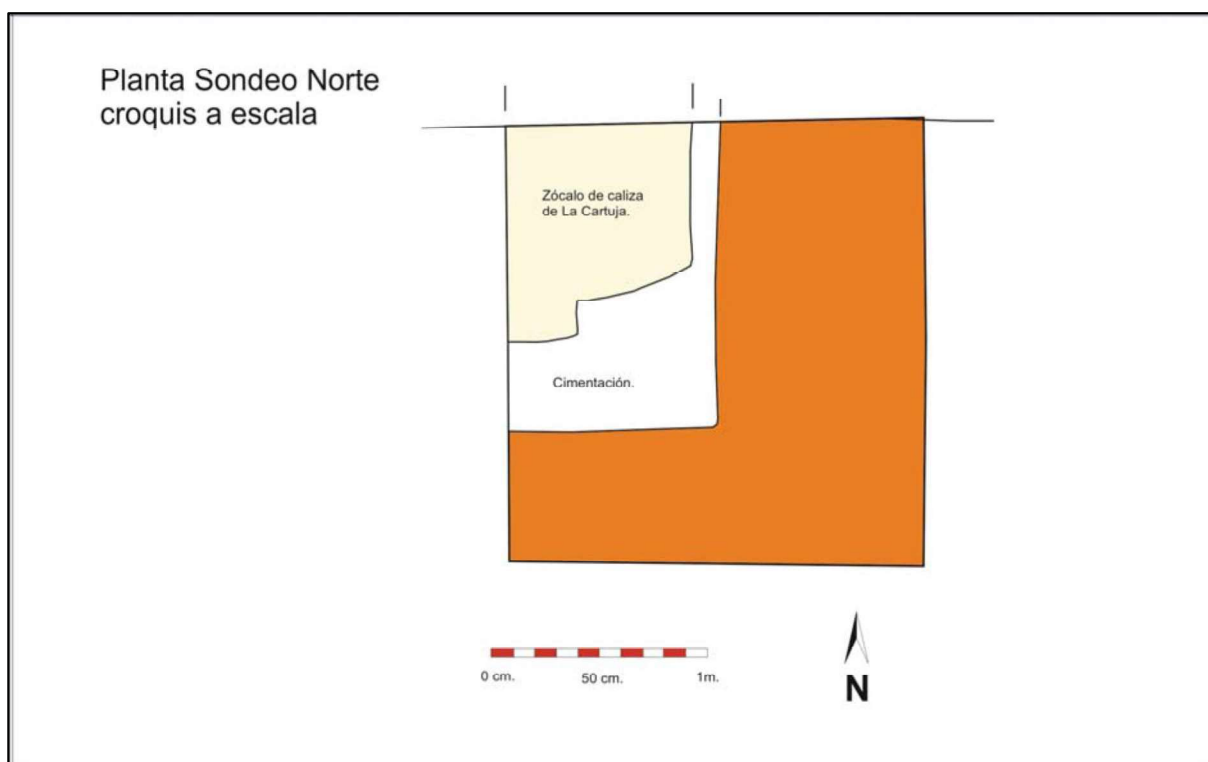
Croquis a escala de la planta del Sondeo Norte.
